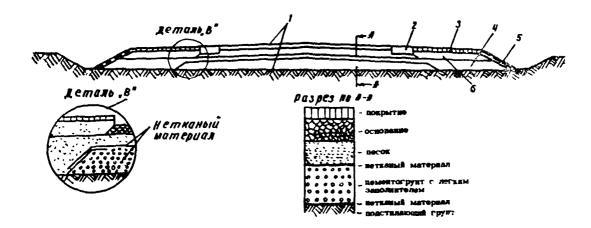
Схема конструкции с теплоизолирующим слоем из пементогрунта с порястым заполнятелем:
